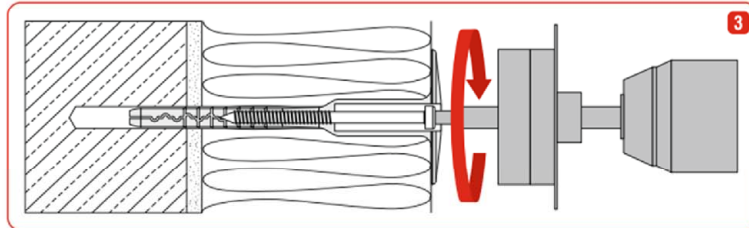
und 4 Die Spezialschraube mit dem Setzwerkzeug Thermodrive-V2 eindrehen.
